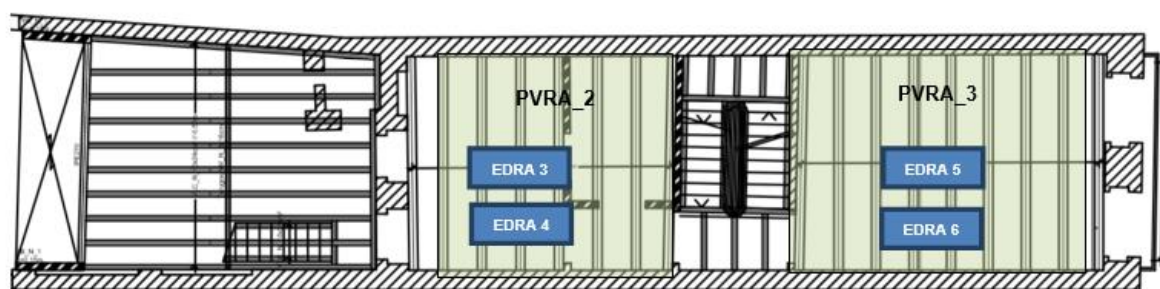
Planta do piso 3, com identificação esquemática dos pavimentos e ensaios dinâmicos
